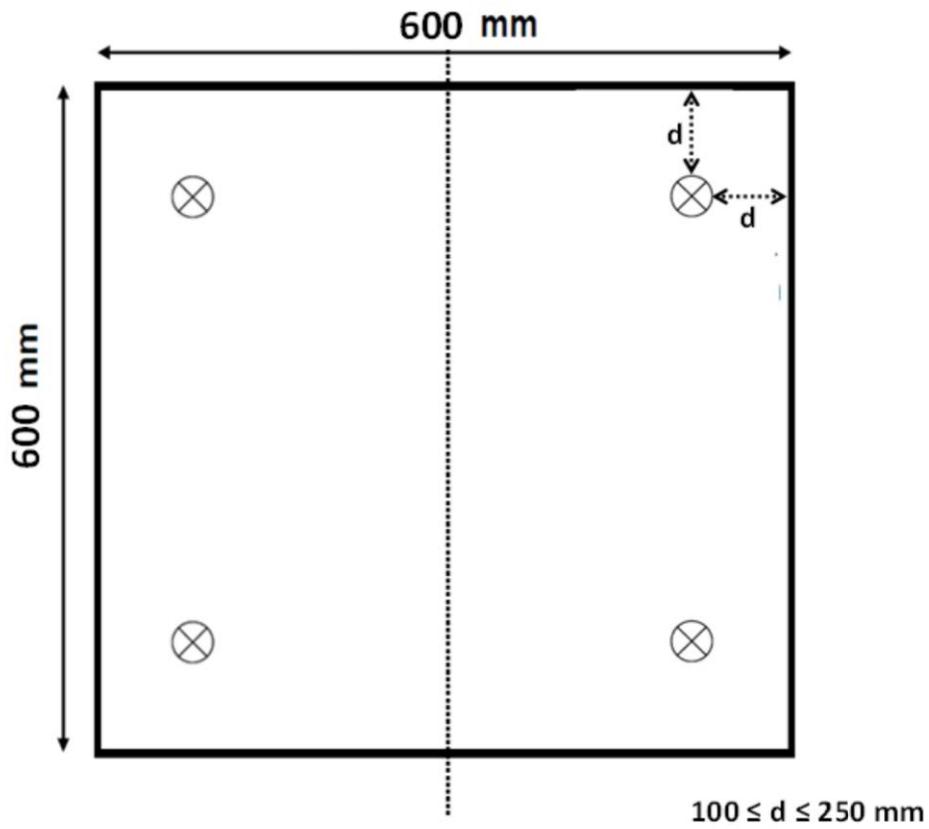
Fixations mécaniques des panneaux de 600 mm x 600 mm.
